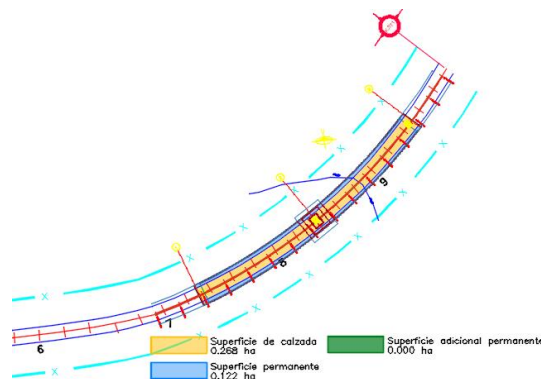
Proyecto del Puente el Horganal 570+800.
